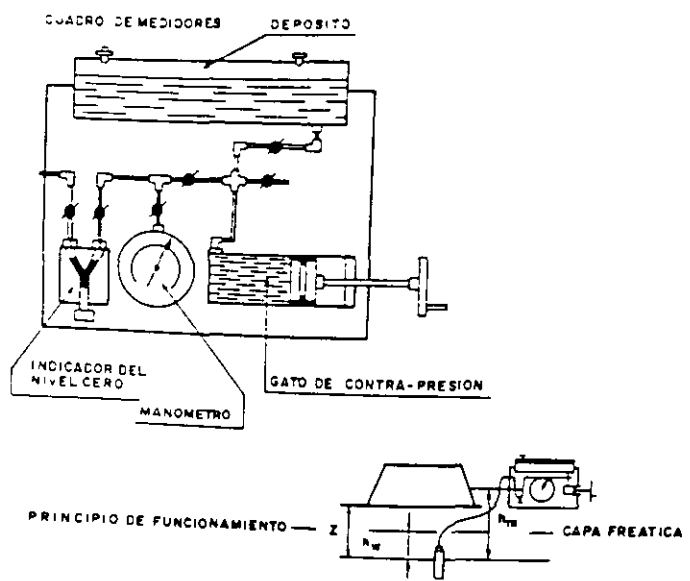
Piezometro a contra-presión hidráulico (MOD. LPC).
